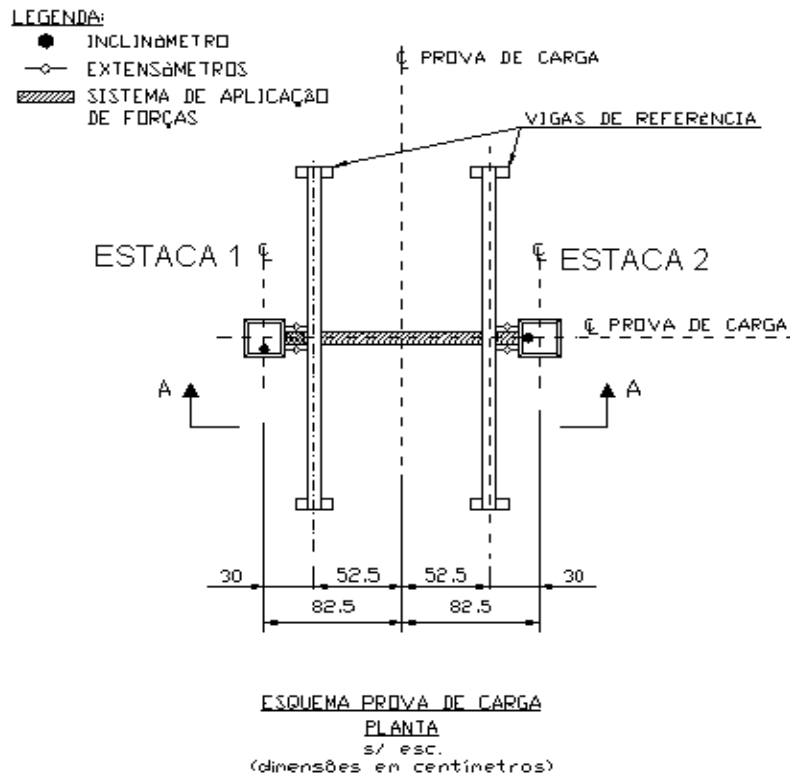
Planta da prova de carga (Adaptado de GUIMARÃES, 2007).
